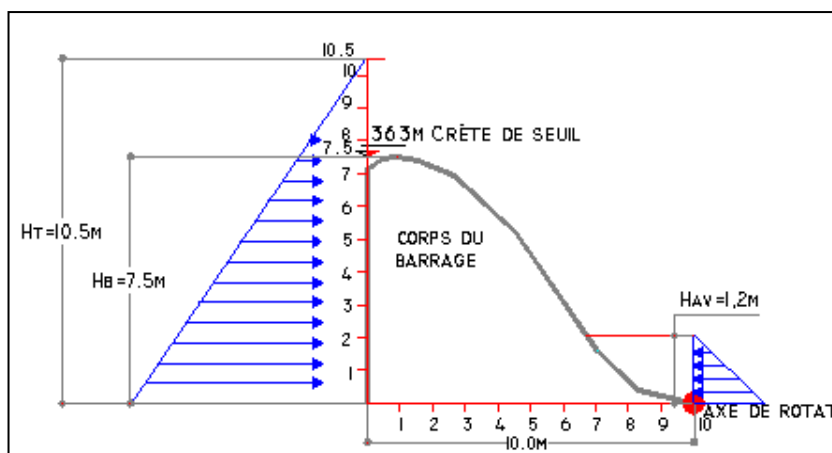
Poussée amont et aval exercée sur le corps du barrage
